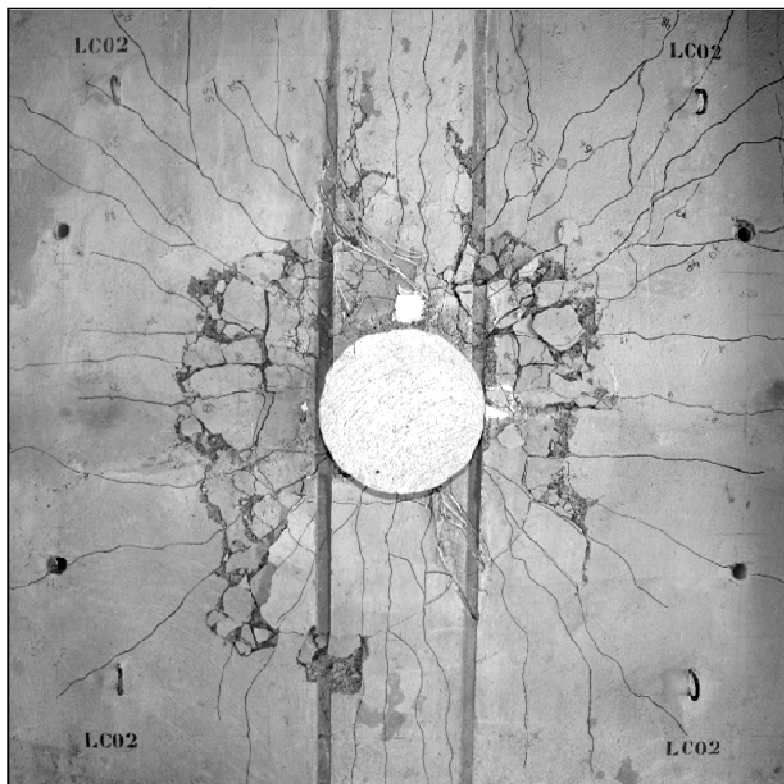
Mapa de Fissuração da laje LC02
